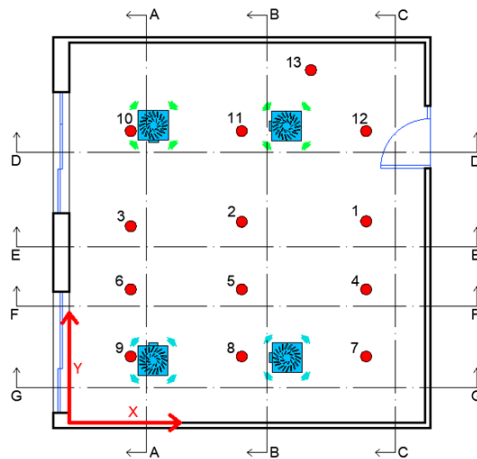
Planimetria con individuazione delle sezioni di riferimento: A-A; B-B; C-C
